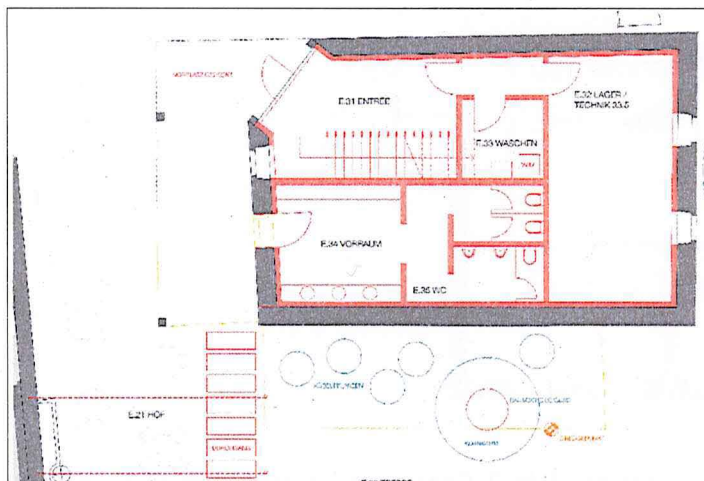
Grundriss Remise, Erdgeschoss mit Toiletten und Lager
